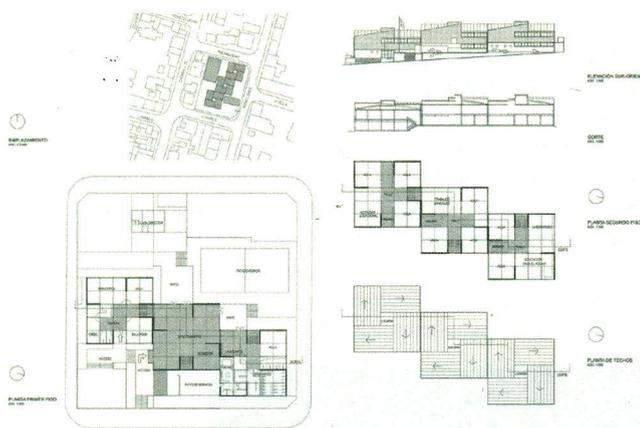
Emplazamiento, plantas, elevación y corte de la Escuela N° 7 de Puerto Montt. Fuente: dibujos de la autora a partir de diferentes planimetrías publicadas de la obra.
